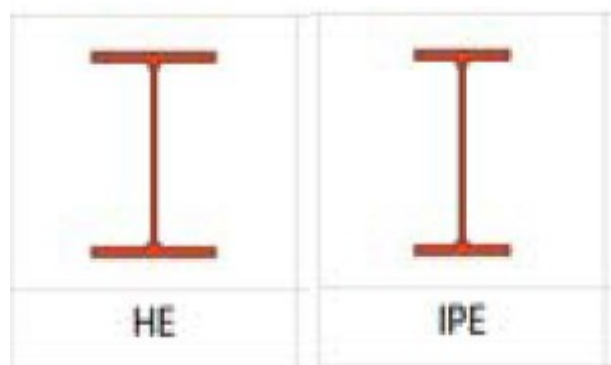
Geometría de los perfiles tipo HE e IPE
